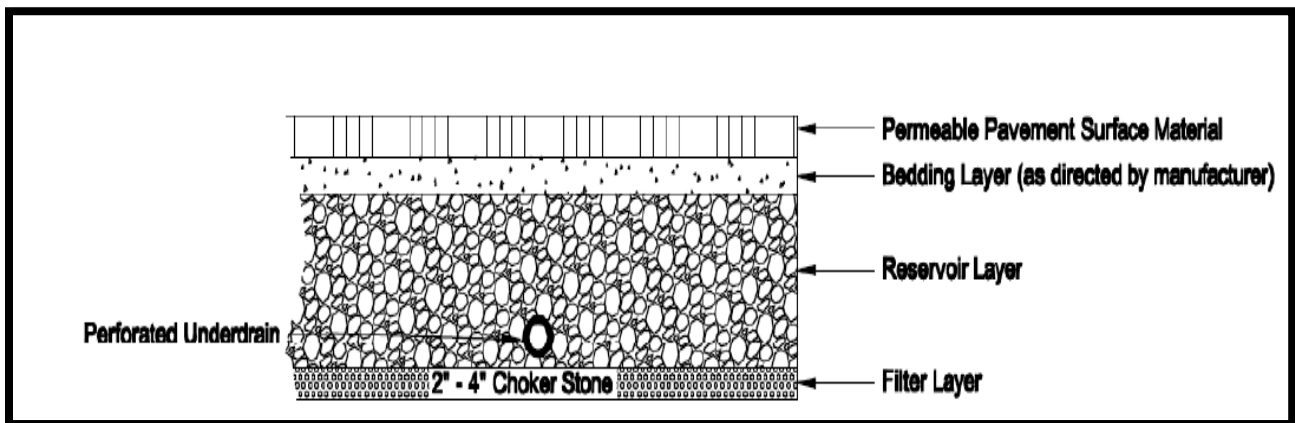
Sistema de drenaje pluvial para pavimento permeable con tubería perforada
